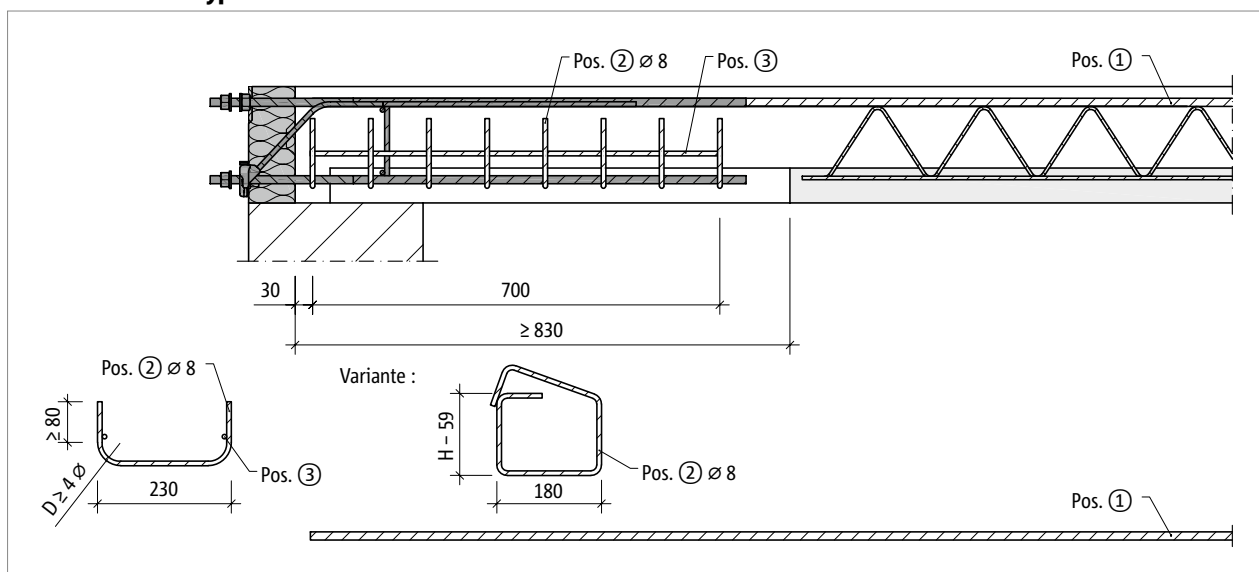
Schöck Isokorb® T type SK-MM1-VV1 : renforcement sur site pour mode de construction semi-préfabriqué, coupe. Variante d'étrier en tant qu'armature transversale constructive dans l'armature inférieure de la dalle.
